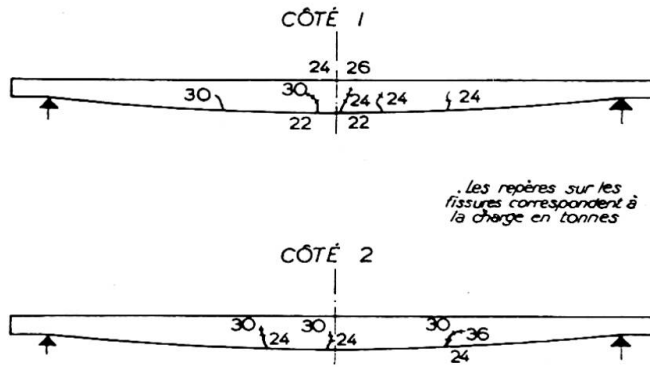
Relève des fissures avant rupture sur les tranches du panneau de 9 cm. essayé à la flexion
